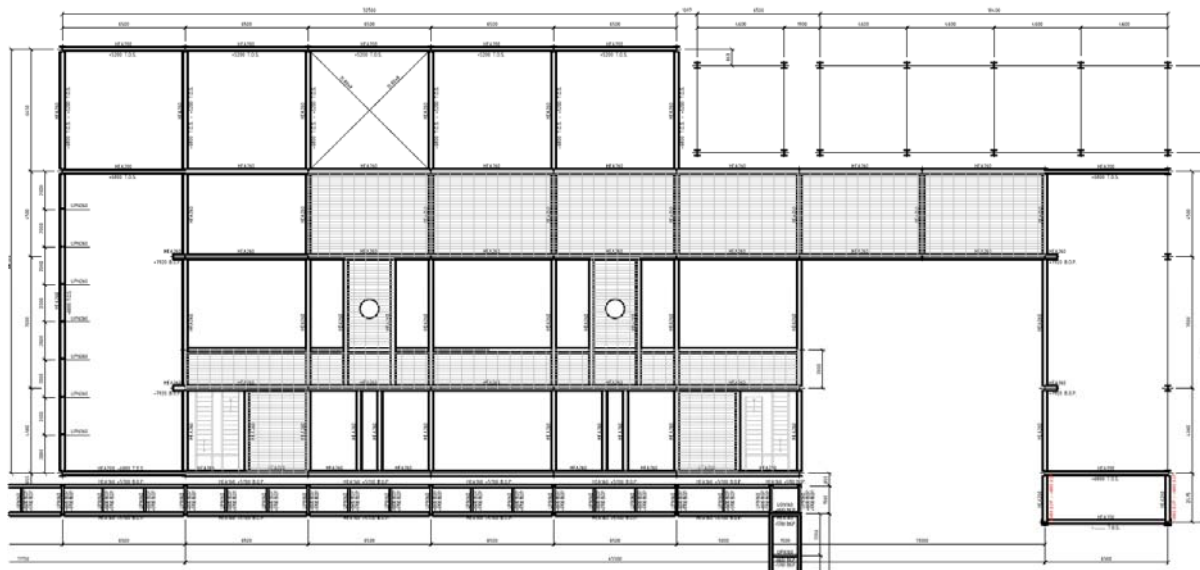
Pianta impalcato a quota +8.05m dal P.C.
